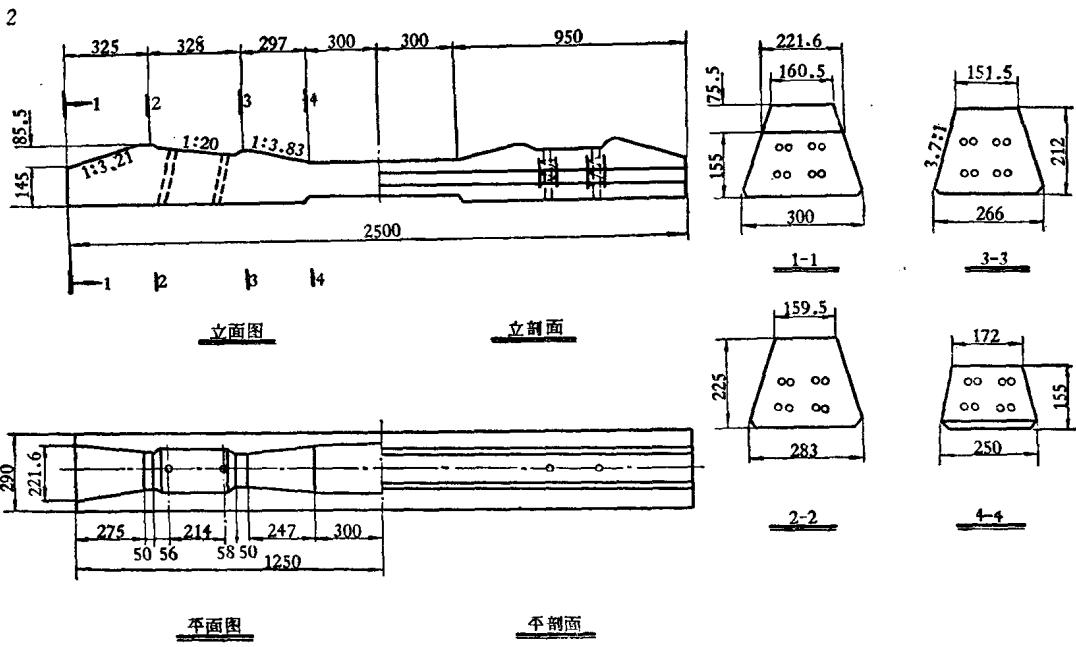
“筋Ⅱ-62研”型预应力先张法钢筋混凝土轨枕结构型式
